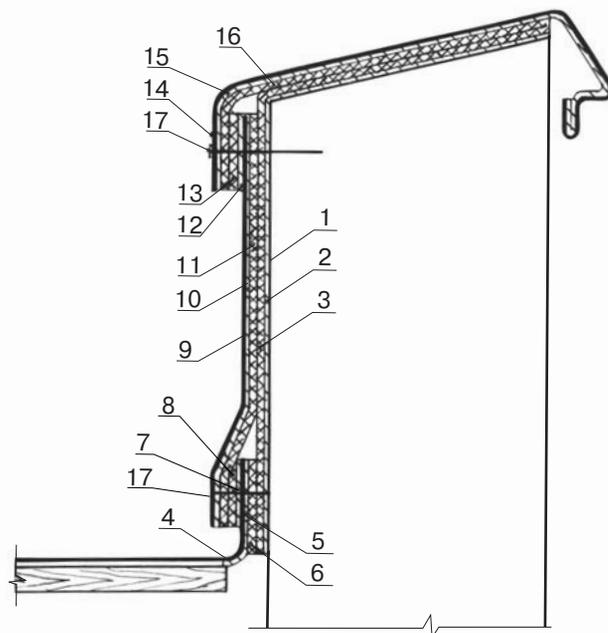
Схема герметичного окрытия брандмауэра или парапета: 1 – зона очистки поверхности; 2 – пропитка Лукаром-ОП или ХСПЭ лаком; 3 – лента Абрис С-ЛБ; 4 – примыкание металлического кровельного покрытия; 5, 6, 8, 11, 16 – прокладка лентой Абрис С-ЛБ; 7 – грунтовка на отгибе кровли Лукаром-5 или ХСПЭ лаком; 9 – настенное металлическое покрытие; 10, 12, 15 – грунтовка Лукаром-5 или ХСПЭ лаком; 13 – прокладка Абрис С-ЛБ, 14 – металлическое покрытие с отворотной лентой и капельником; 17 – оцинкованный дюбель
